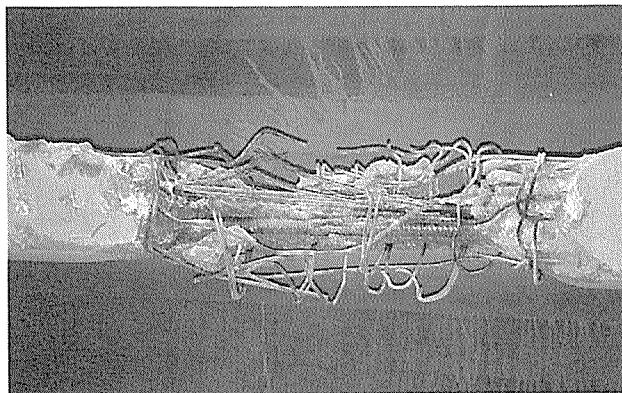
損傷状況 (P 102～P 103, 中桁 (G 2))
